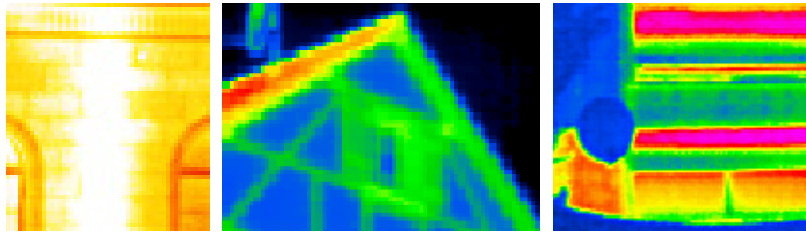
Detailausschnitt: Massivgebäude – Fachwerkhaus – Fertighaus
